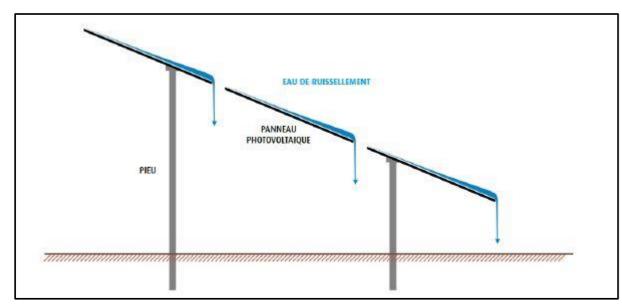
Schéma ruissellement des eaux pluviales sur les panneaux
